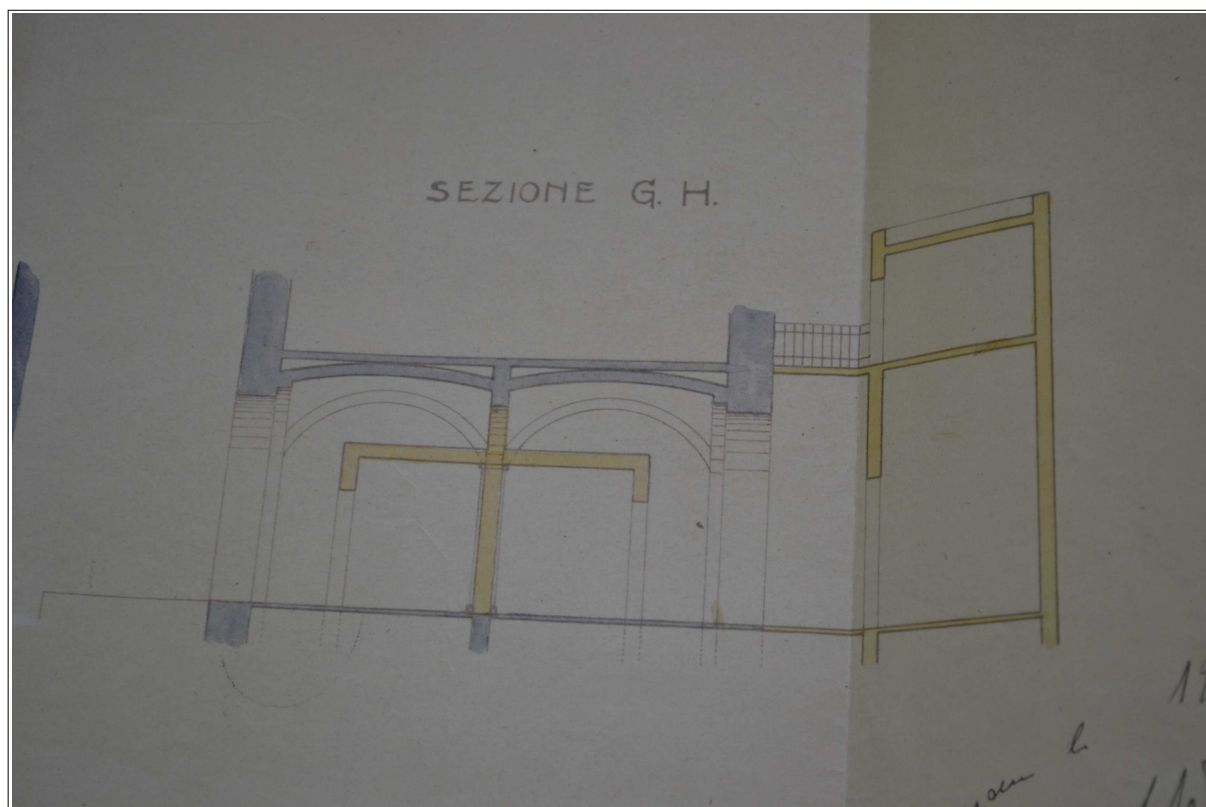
Corpo Est: sezione G-H (posizione visibile nella foto 1-2)
